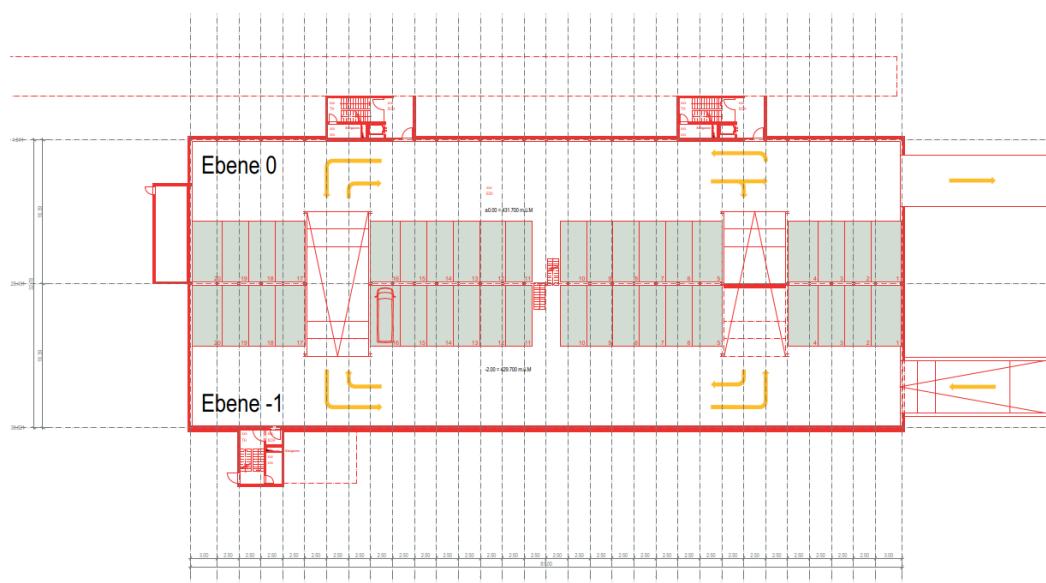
Grundriss Ebene Zustellfahrzeuge (Richtprojekt, ANS Architekten)
